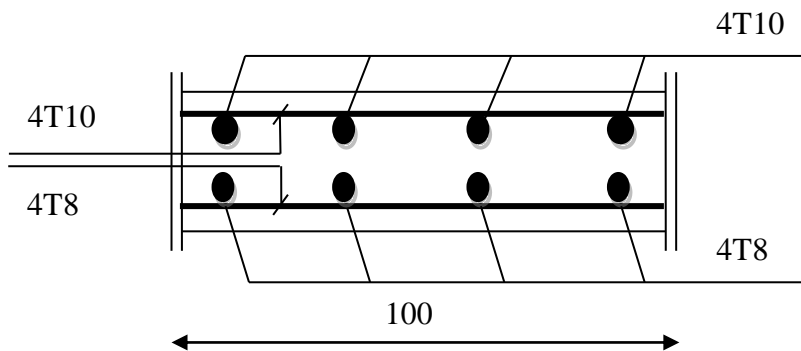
Dessin du ferrailage de la dalle pleine.
